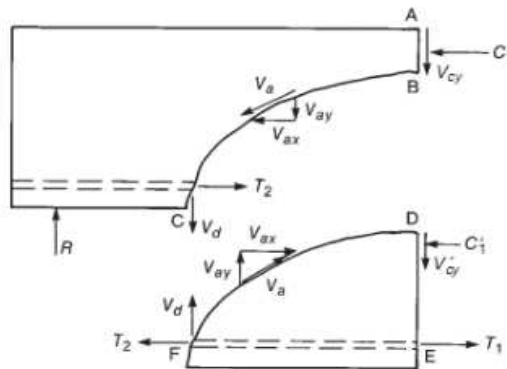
Cisaillement dans un élément poutre en B.A (ou voile-structurel) sans armature transversale [8].
